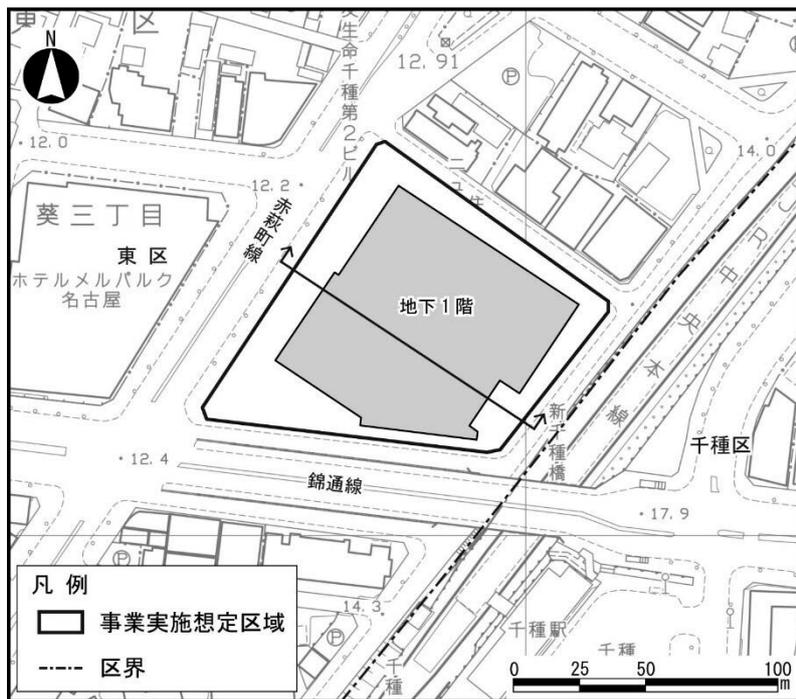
(1) 地下1階平面図及び断面図 (A案)
